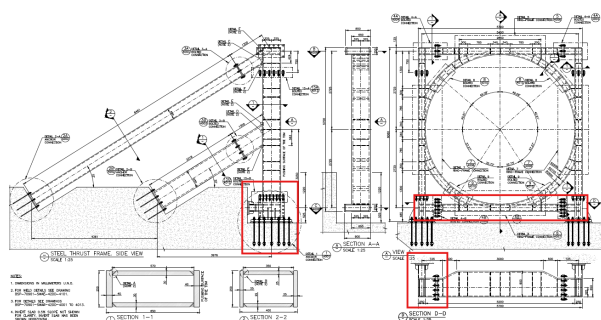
Diseño con viga bypass de la estructura de empuje (Fase 3).
